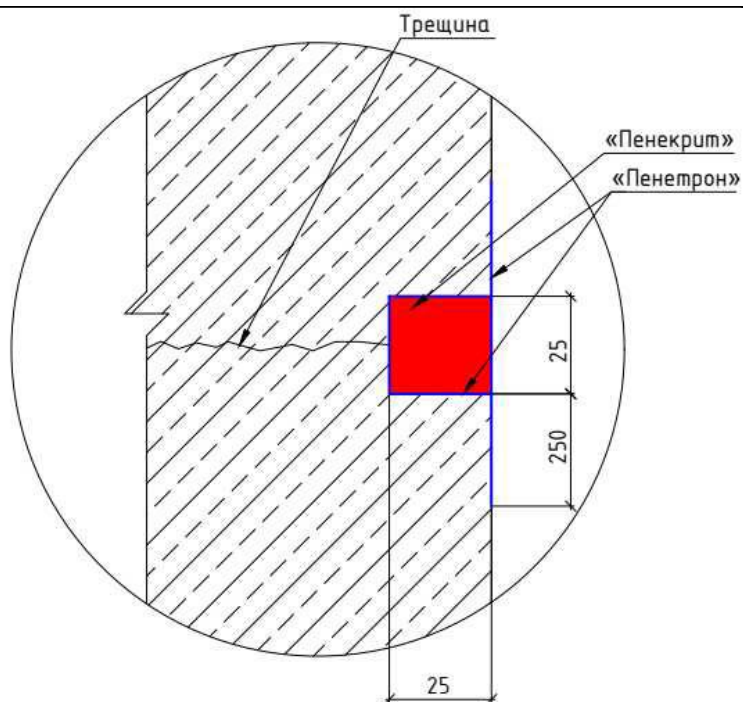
Схема гидроизоляции трещины при
